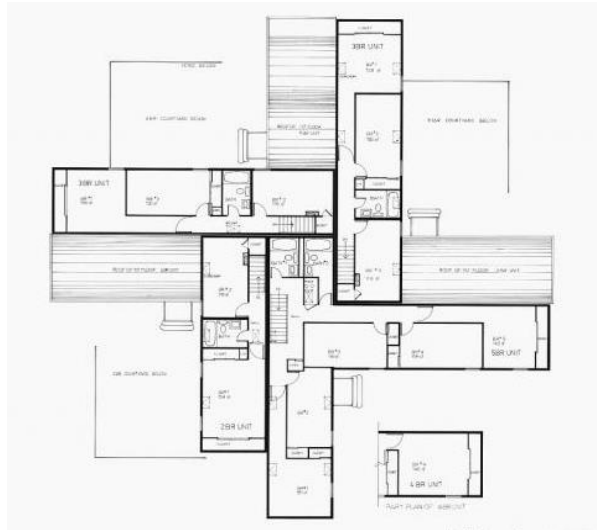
Planimetria ansamblului de la „Oriental Gardens”
